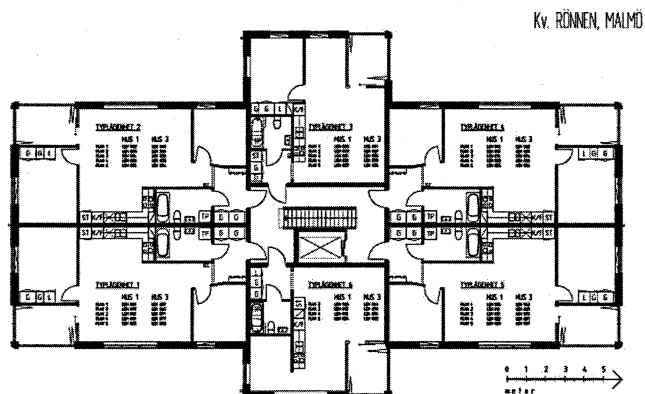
Planlösning för kvarteret Rönnen. Ett våningsplan innehåller 4st 3-or och 2st 2-or. Källa: www.mkbfastighet.se
